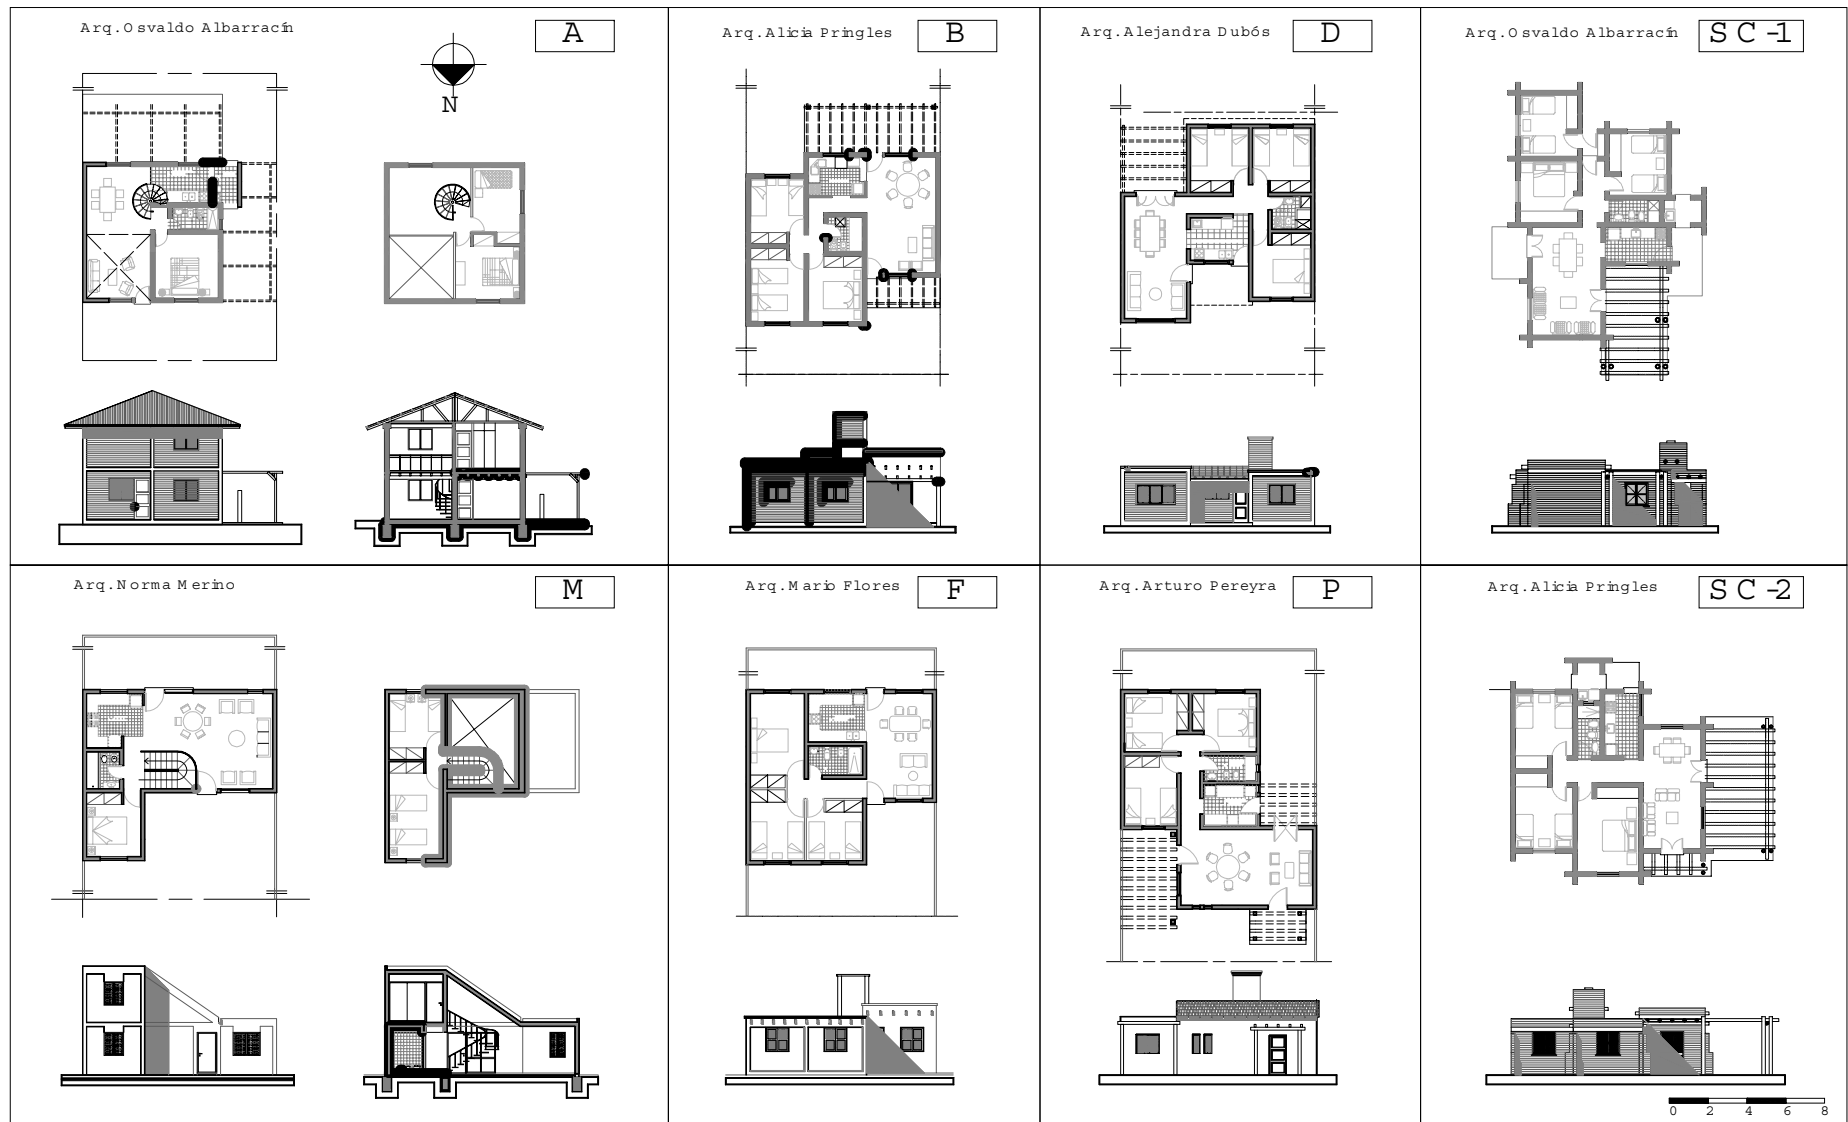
Plantas, cortes y fachadas de las tipologías analizadas
